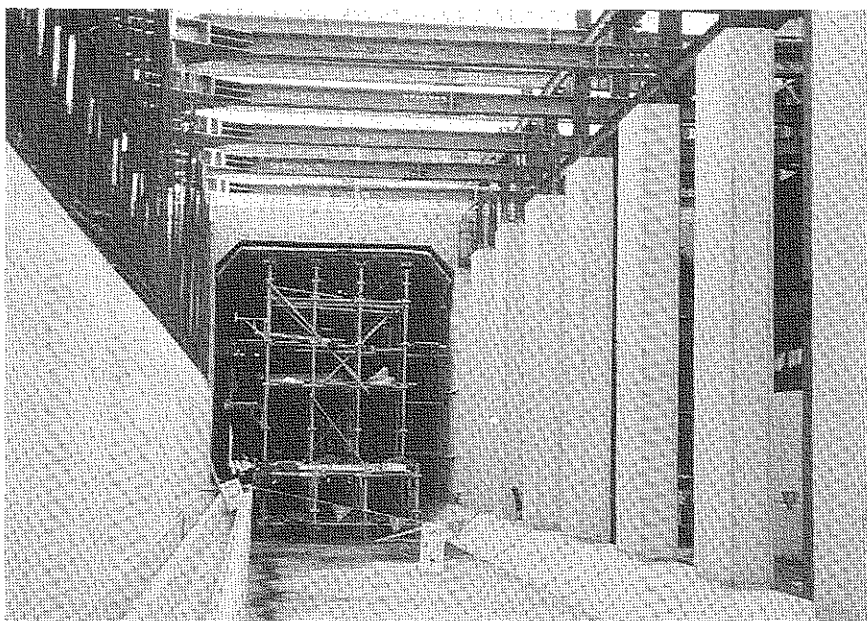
6 - 20 く体鉄筋コンクリート施工状況
